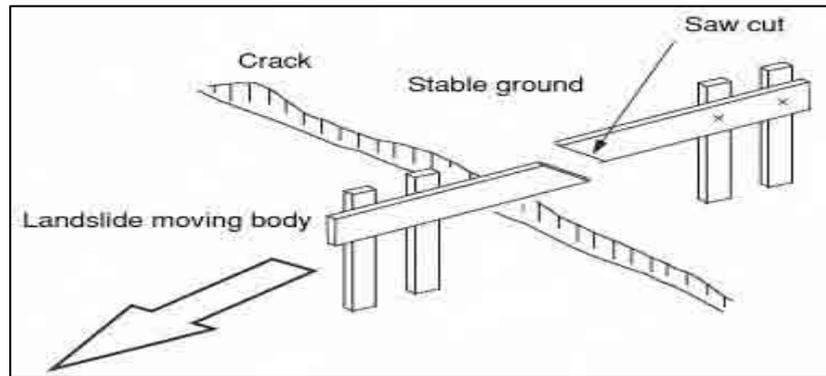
Medición Simple de Grietas en el Terreno
